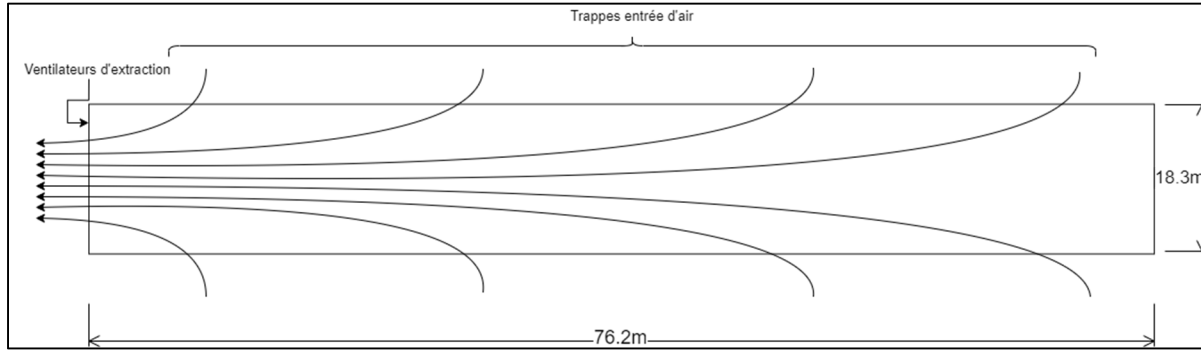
Dimensions et vue de haut du plancher et schématisation de la ventilation tunnel
